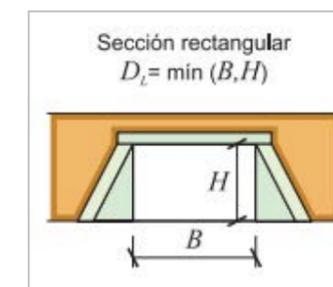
Sección rectangular de la ODT. Fuente: 5.2-IC Drenaje
